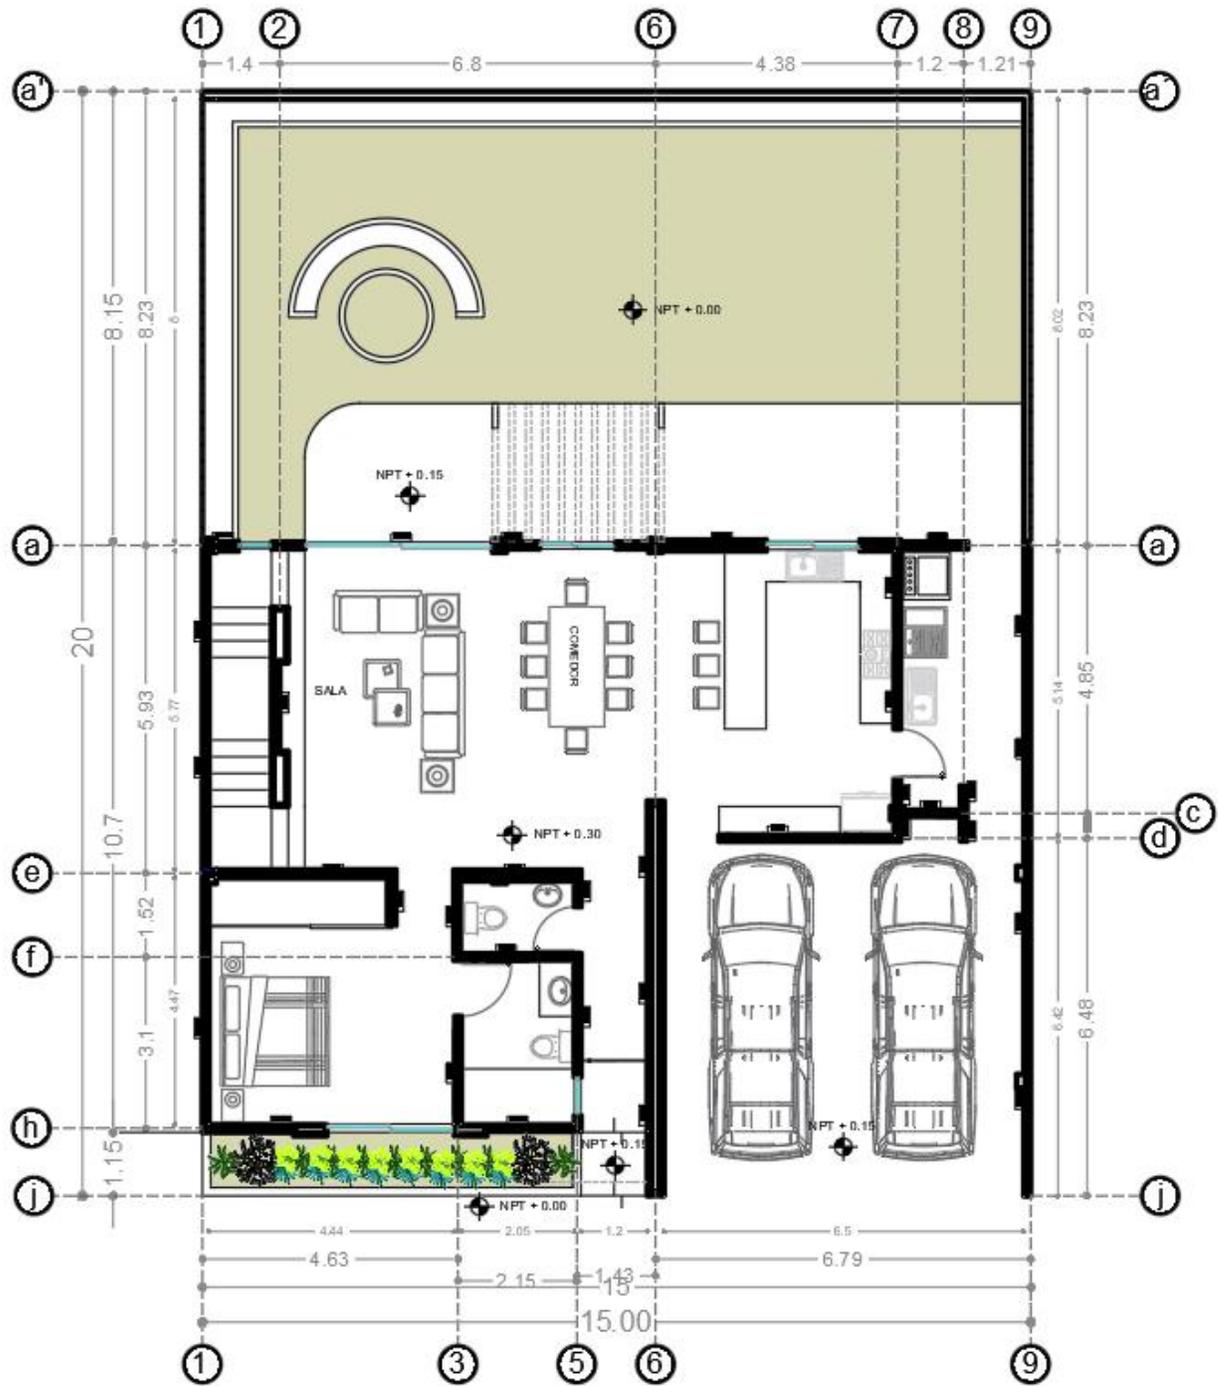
Planta baja "mi casa ecológica" (Muciño, 2022)
